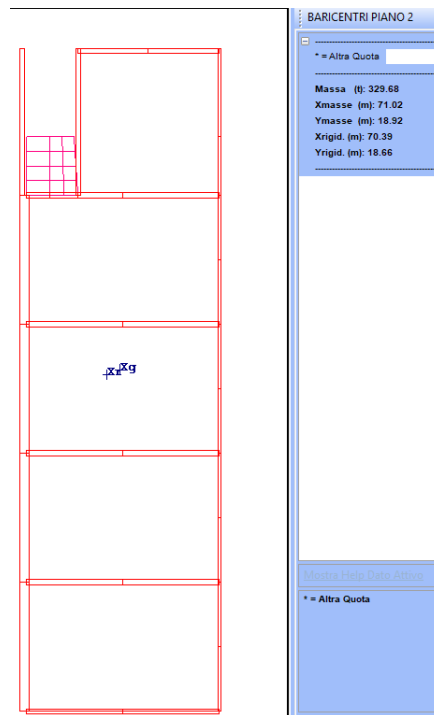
Baricentro masse e baricentro rigidezze piano secondo (piano n°2)
